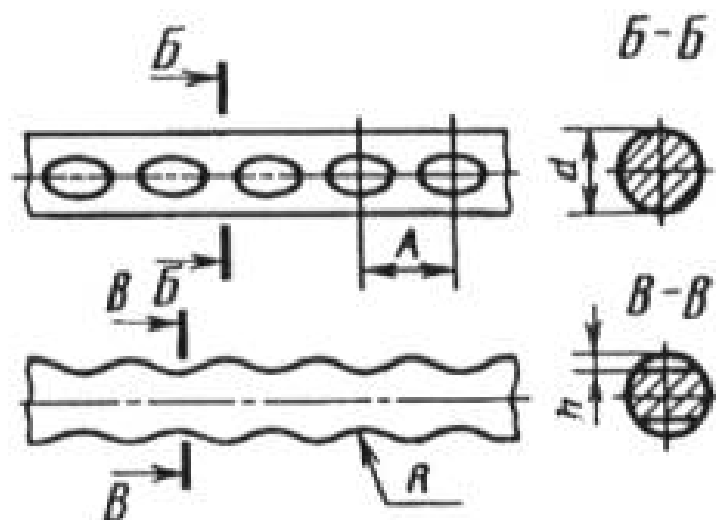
Проволока периодического профиля из качественной углеродистой стали для армирования предварительно напряжённых железобетонных конструкций
